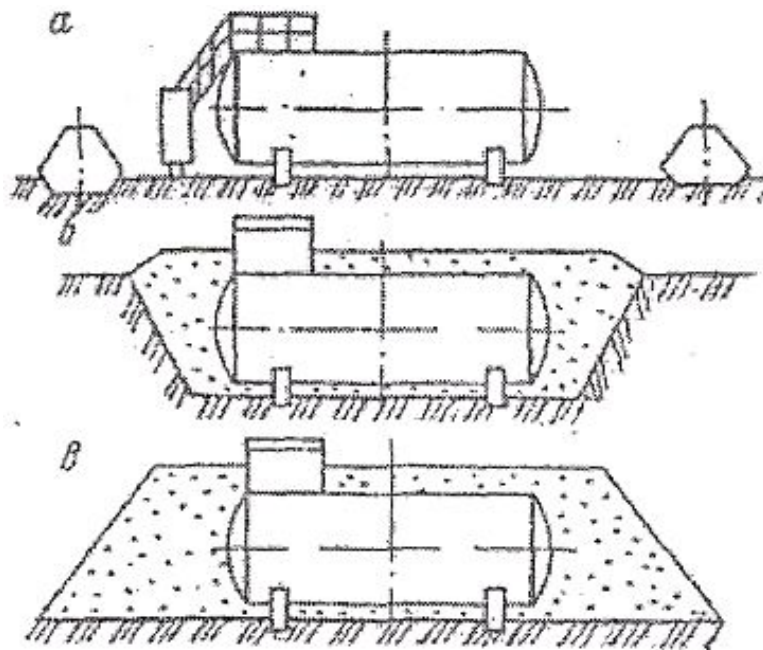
Схемы установки цилиндрических резервуаров: а - надземный резервуар; б - подземный резервуар; в - резервуар с засыпкой
